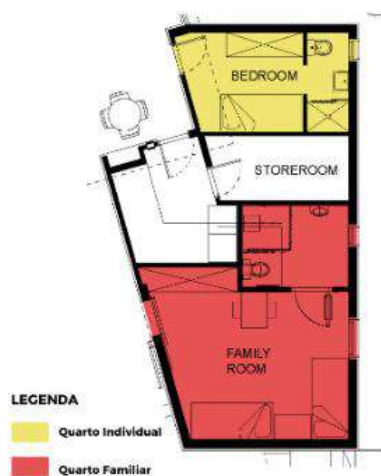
Recorte da Planta Baixa da Area Privativa do Abrigo. Fonte: Modificado de ArchDaily (2018)
